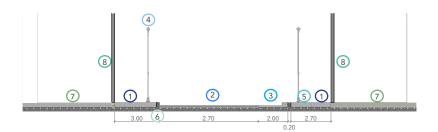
APLICACIÓN EN EL SITIO CALLES TIPO 2
